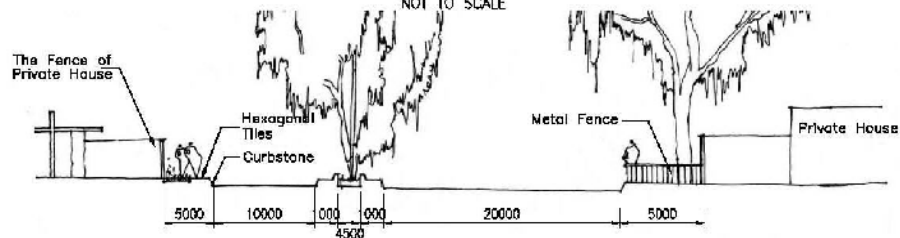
街路横断面图-4 (I-I ~ L-L 断面)
